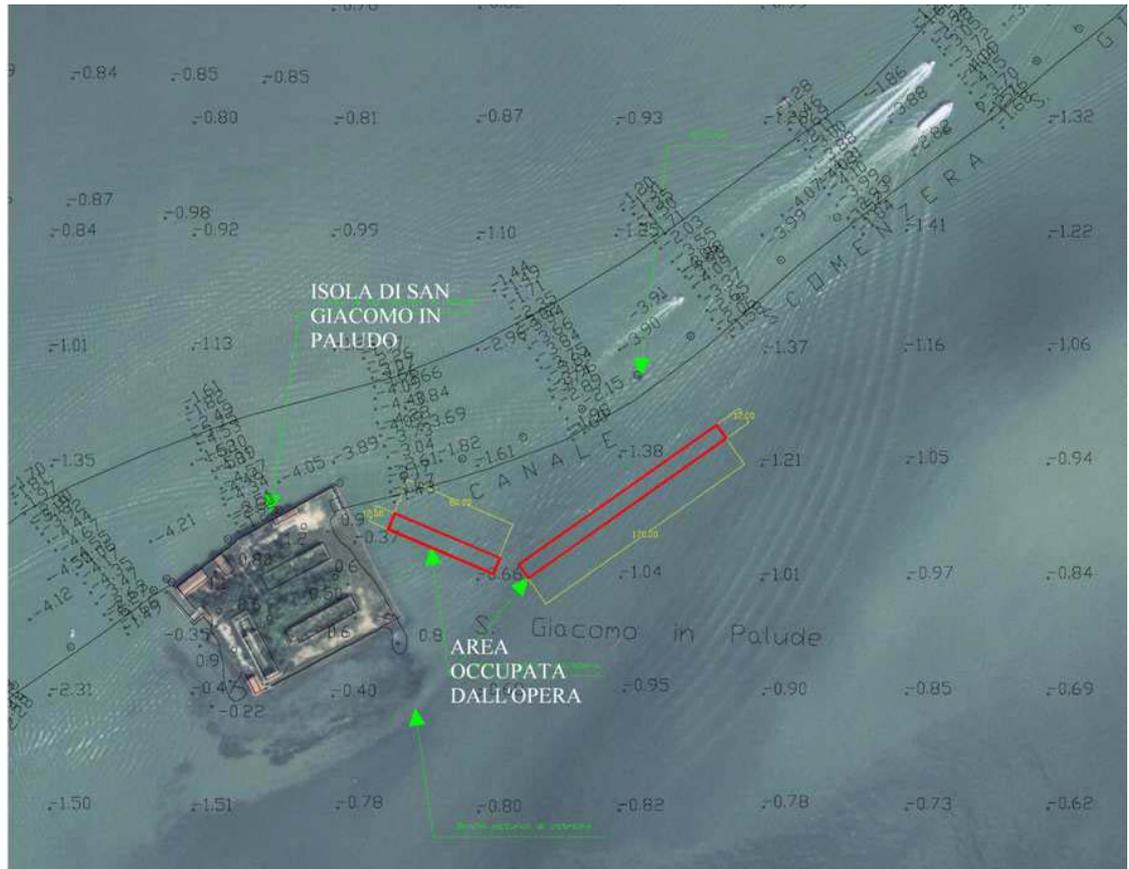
Area dell'intervento di posa delle strutture biostabilizzanti.
